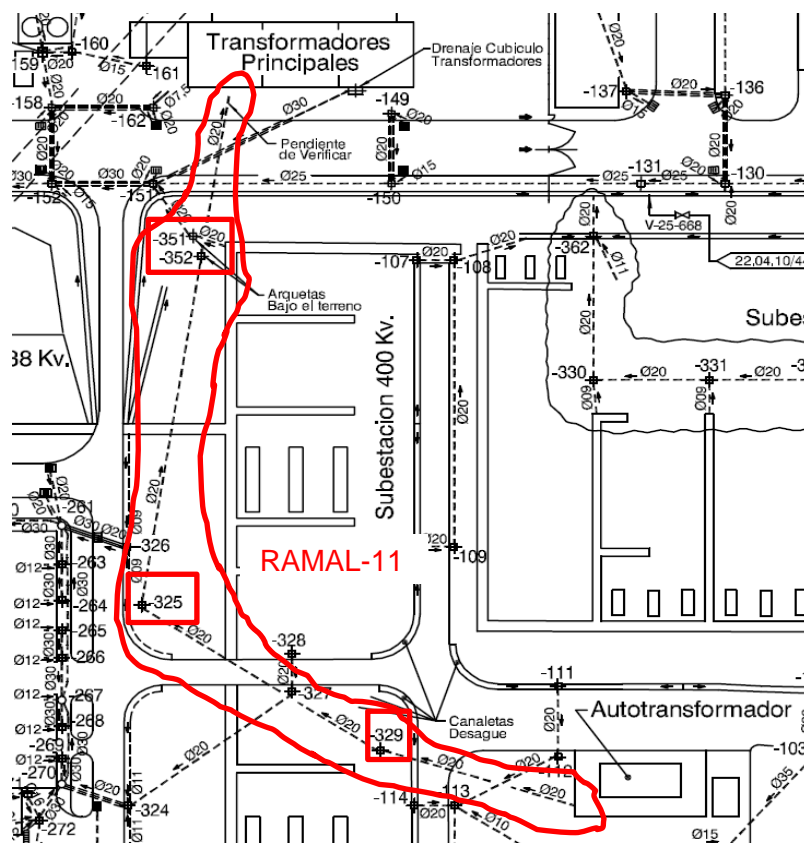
Plano 05.01.06/1 (Sistema general de drenajes - Implantación)
